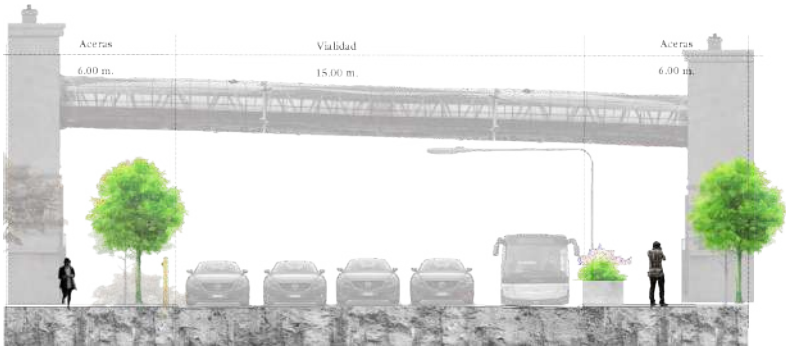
Sección vial de Orchard Road, Singapur.
